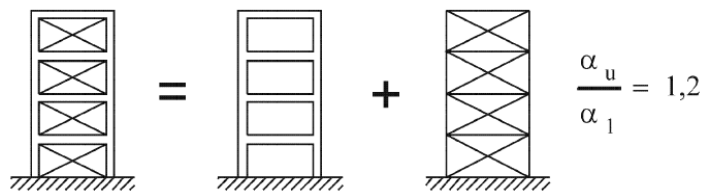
Pórtico simples com contraventamento centrado com zonas dissipativas no pórtico e nas diagonais tracionadas (corresponde ao ponto 6 da Tabela 2.15) (Fonte: [7])
